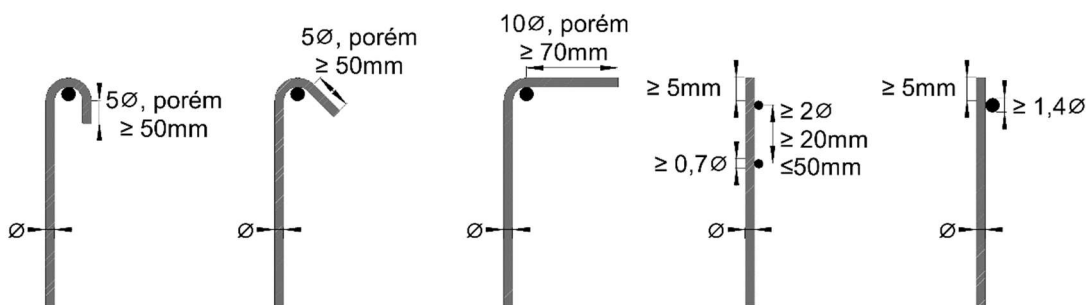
Detalhamento de estribos conforme ABNT NBR 6118 (2014)
